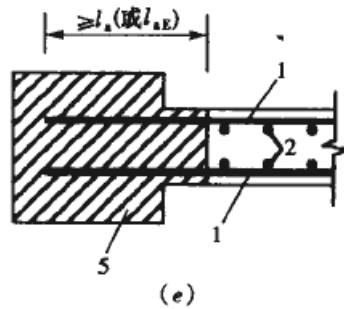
3 钢筋焊接网在墙体端部的构造
